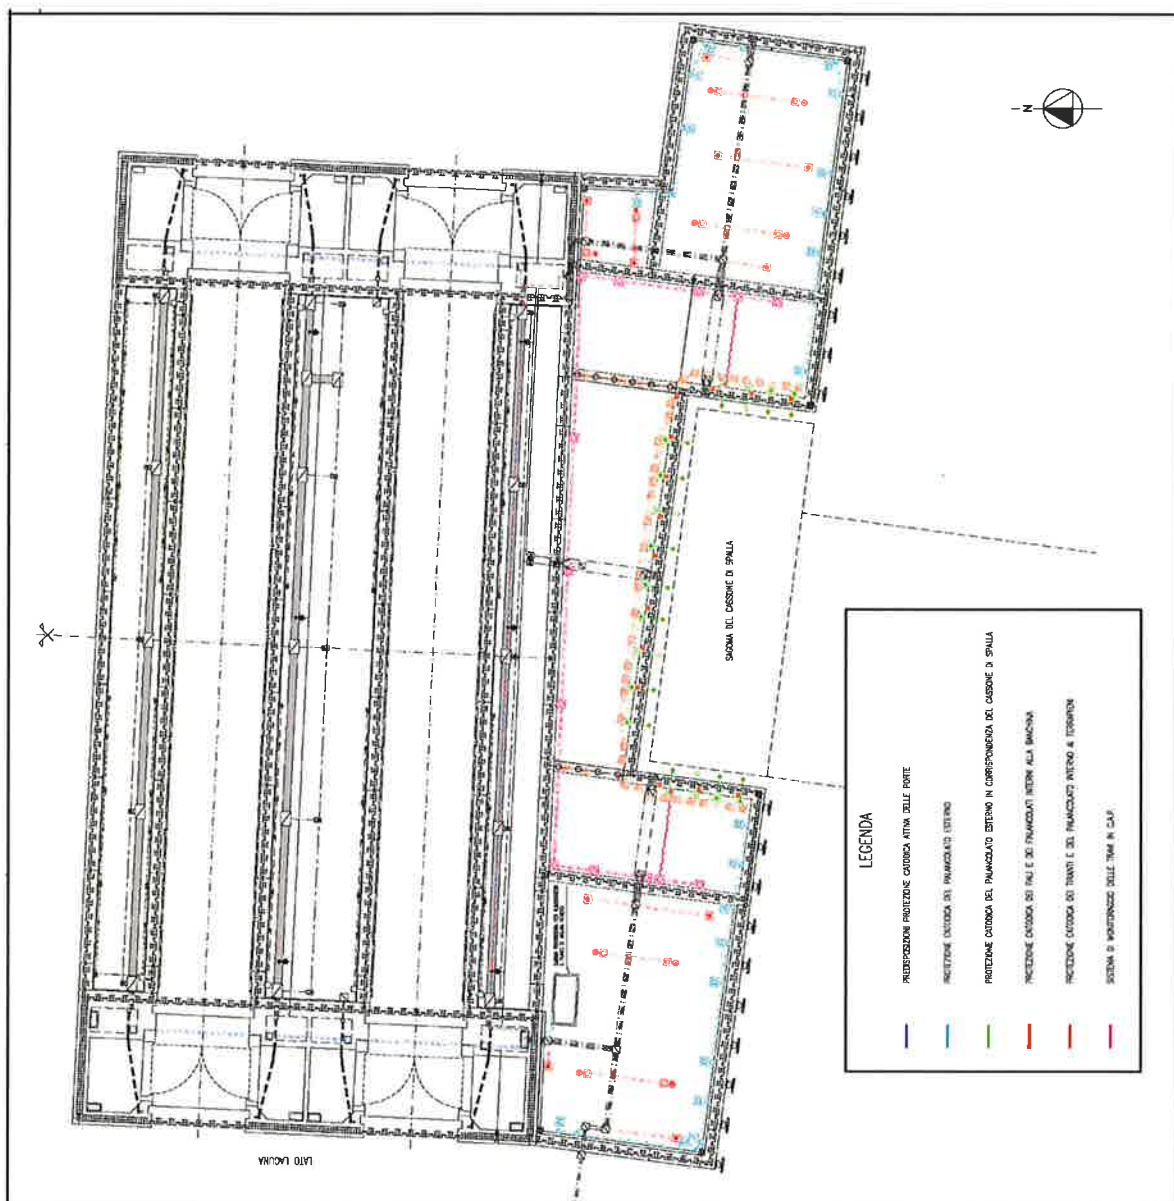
PLANIMETRIA DELLE OPERE SOGGETTE ALLE PREDISPOSIZIONI PER LA PROTEZIONE CATODICA DI WBE 01A
